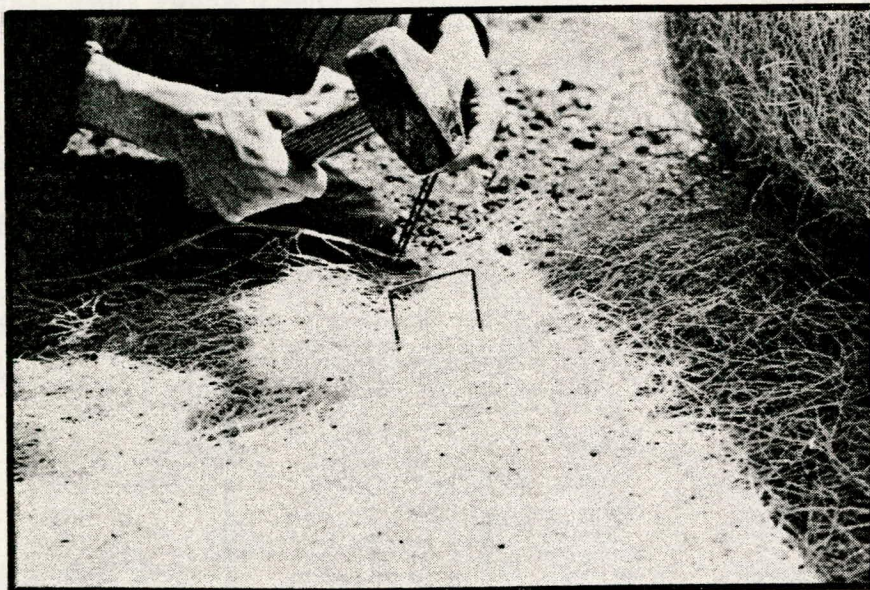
Installation de la couverture Excelsior et des crampons permettant une meilleure stabilisation sur le sol
